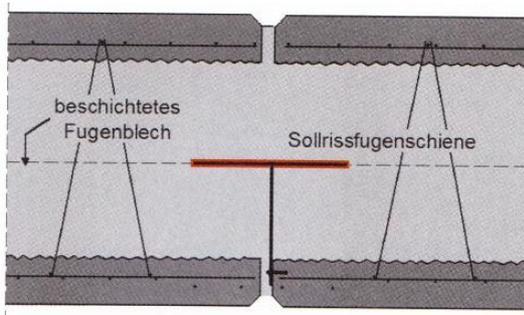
Sollrissfugenschiene (Variante 1) [HOH16]
